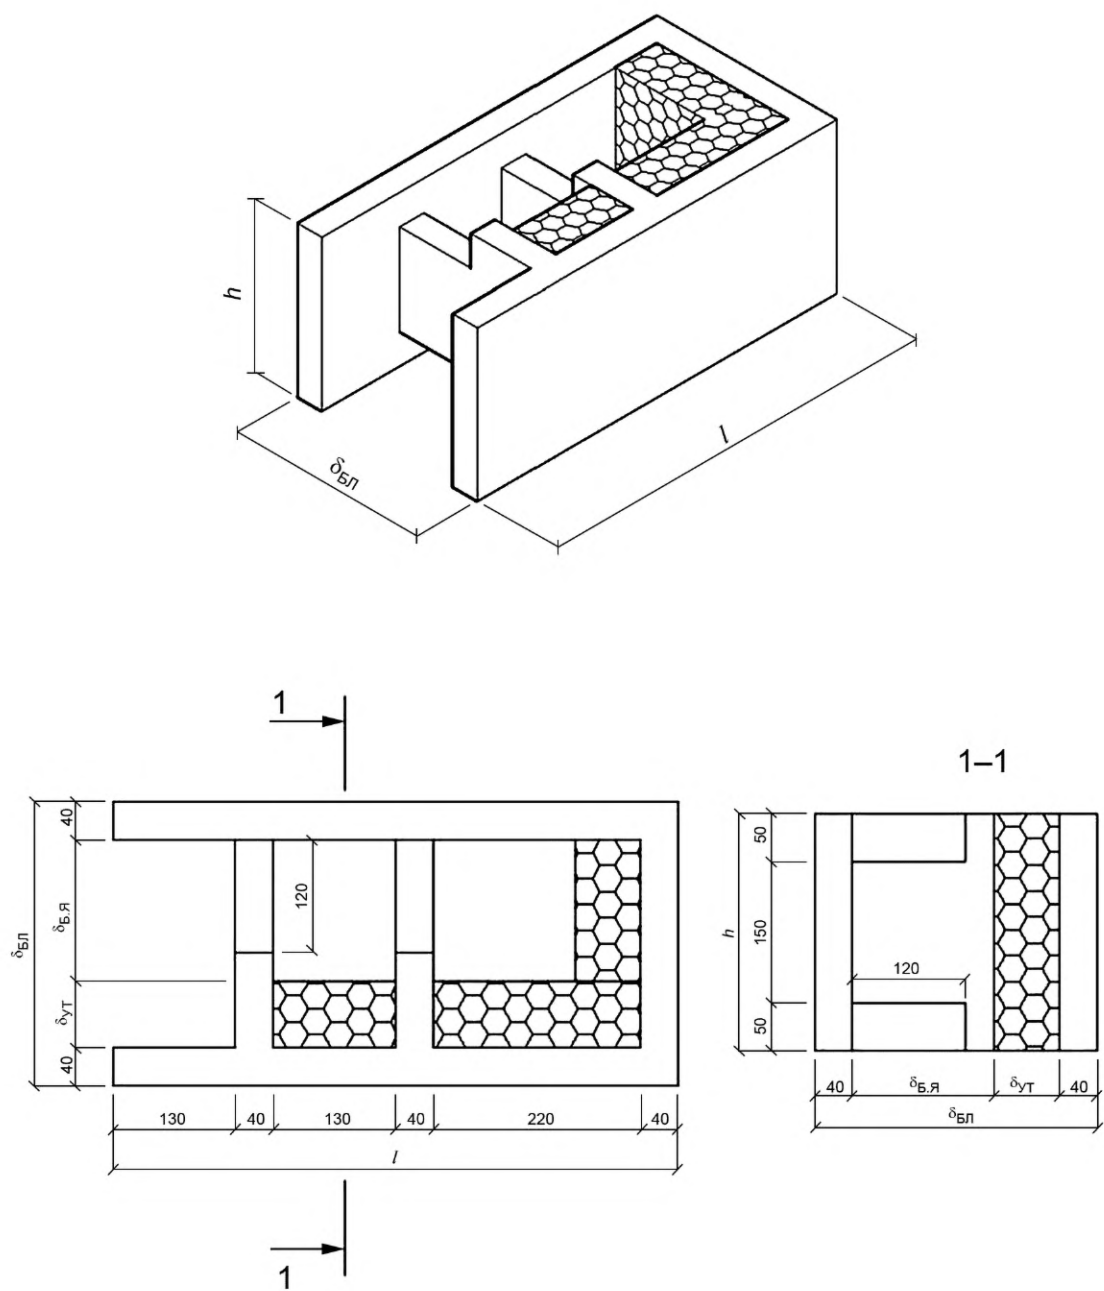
Блок наружной стены угловой утепленный (НС-УГ-УТ-30/15)
